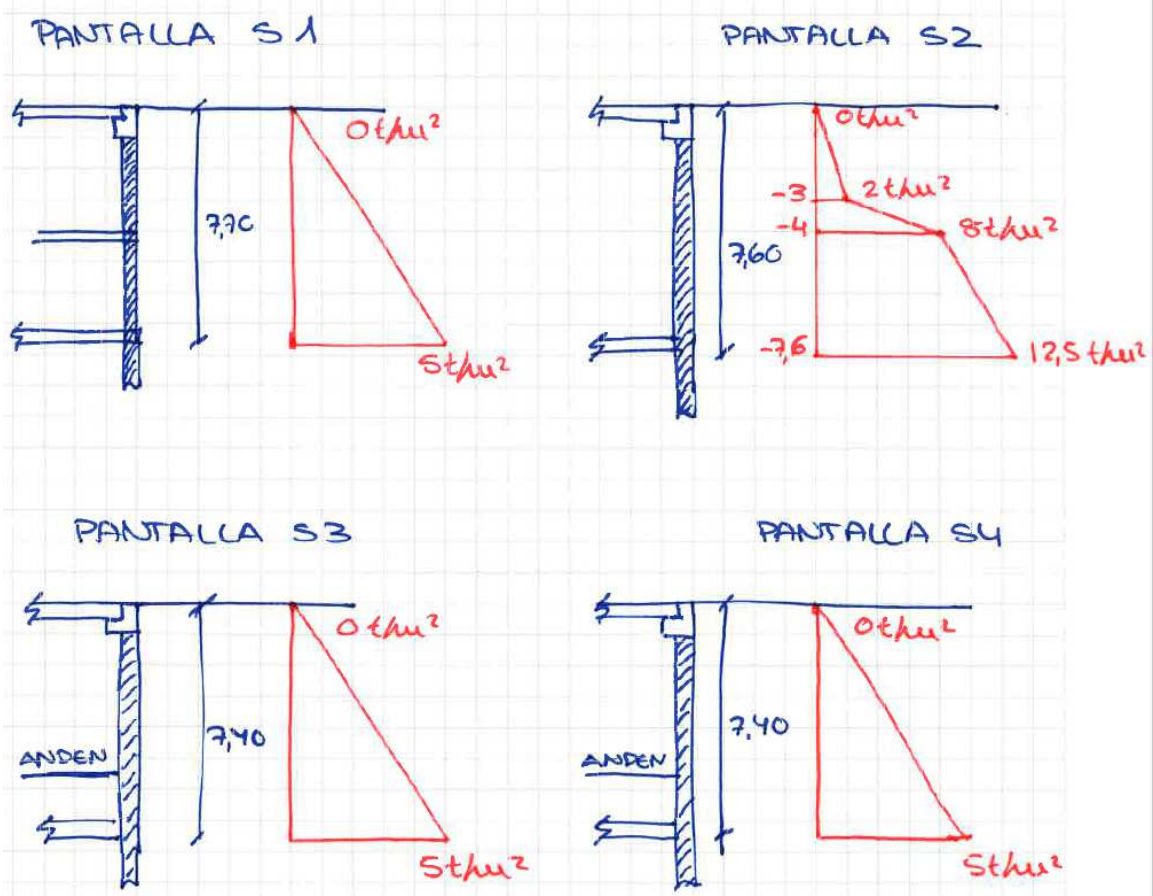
Resumen de Empujes sobre las Pantallas en estado definitivo.
